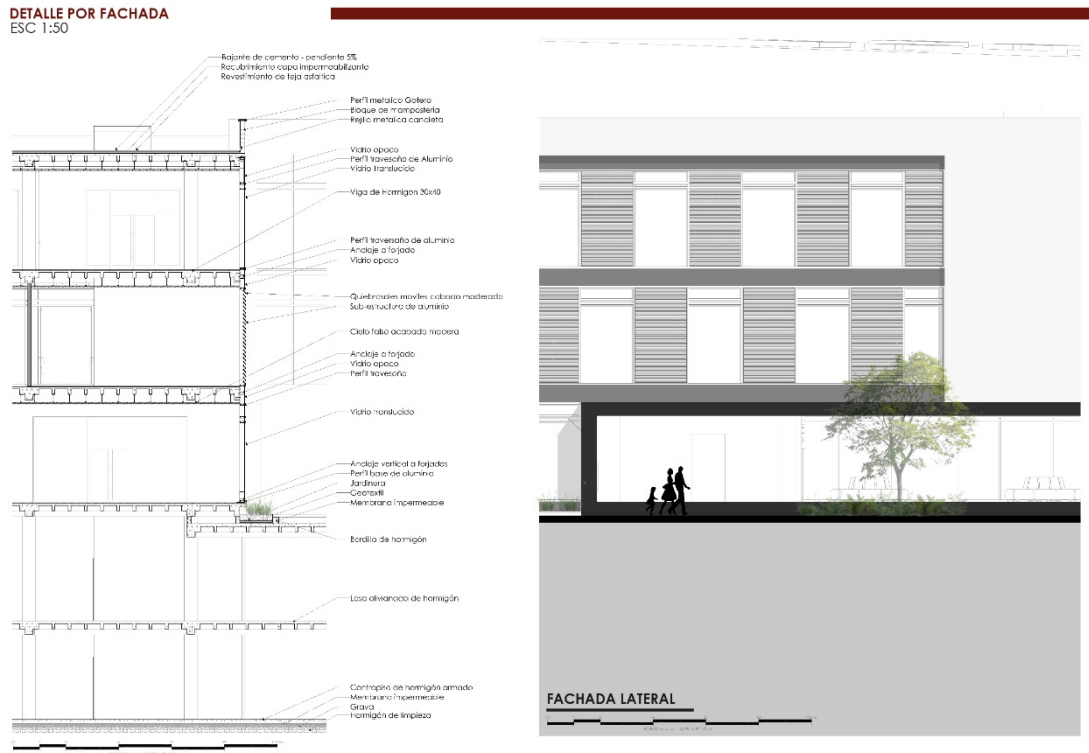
Detalle constructivo - corte por fachada (Elemento Propio)
